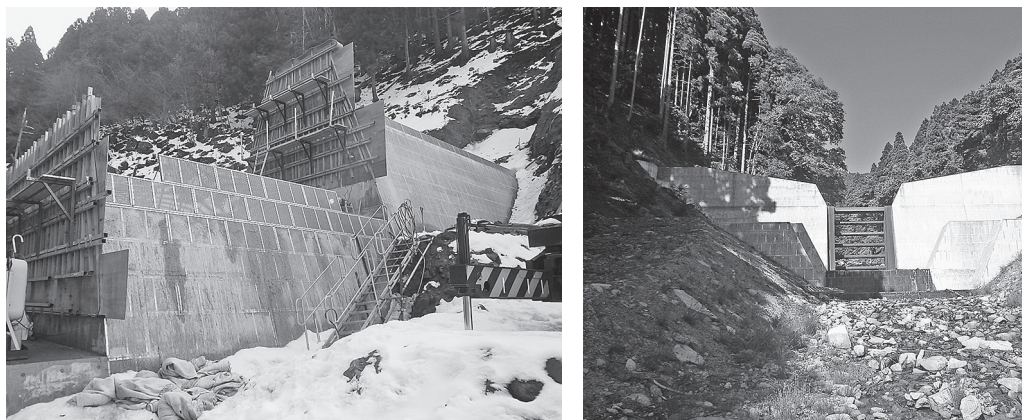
大毛谷川支川砂防堰堤：施工中の状況（左）と完成後（右）
